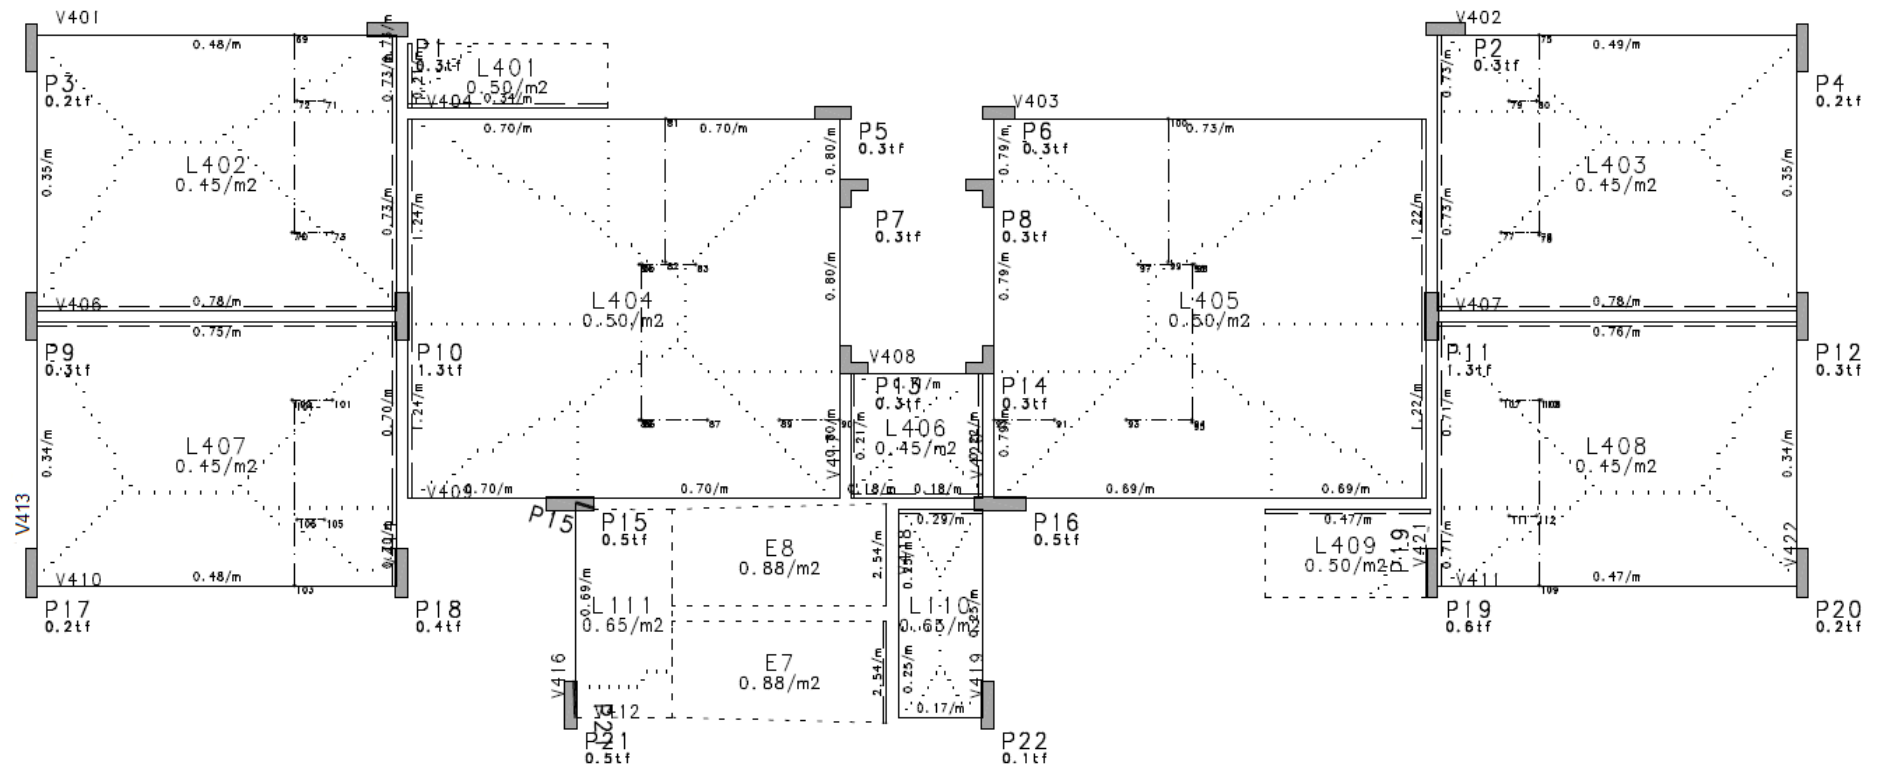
Planta do pavimento 4 do edifício de lajes nervuradas de seção trapezoidal
